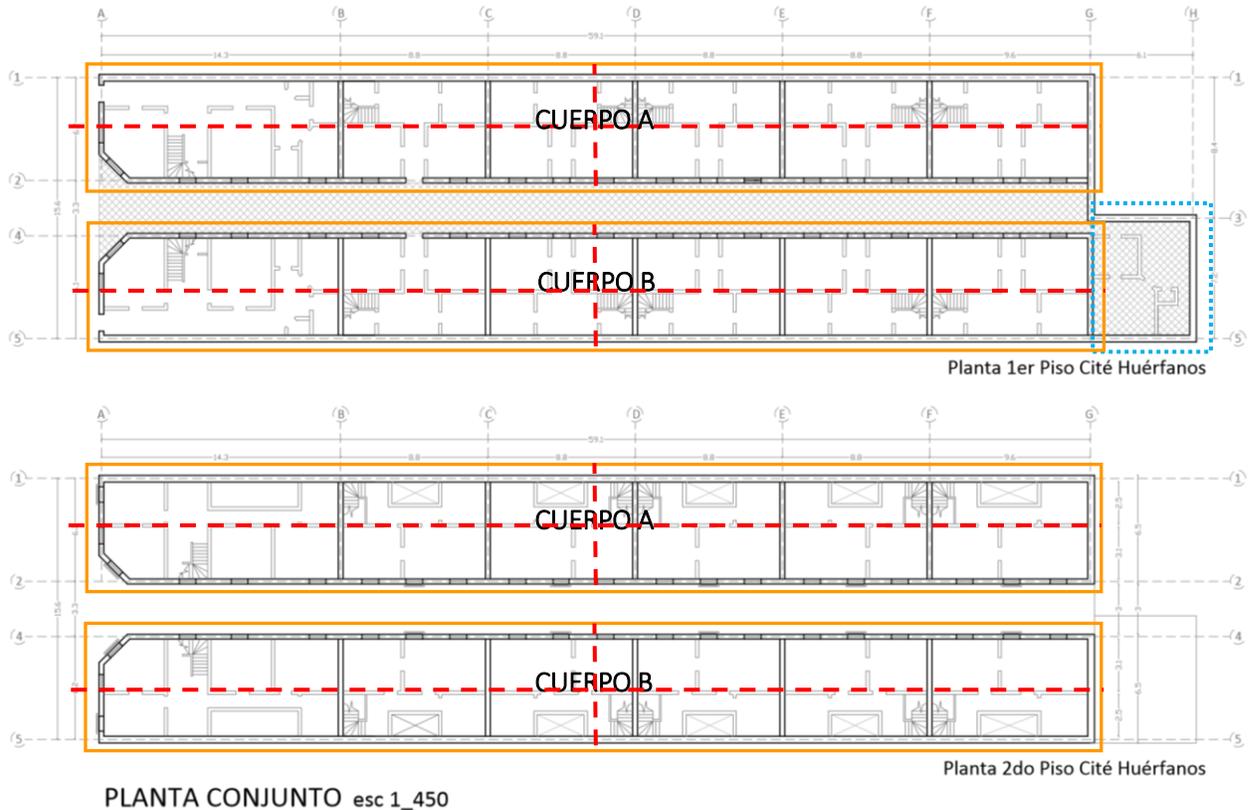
Planta Conjunto ESTRUCTURA Eje ROJO: Ejes de simetría horizontal y vertical.
